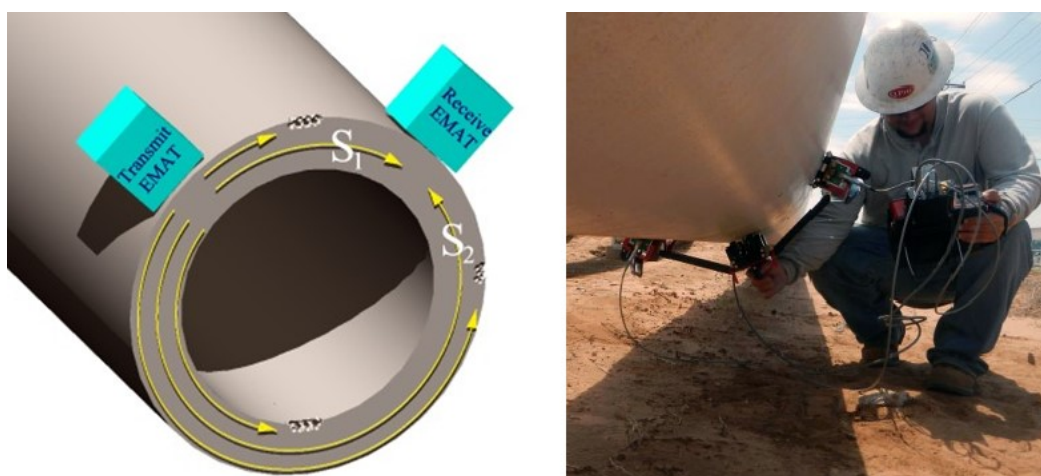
Esquema de configuración axial e inspección de tubería con ondas guiadas MRUT.
